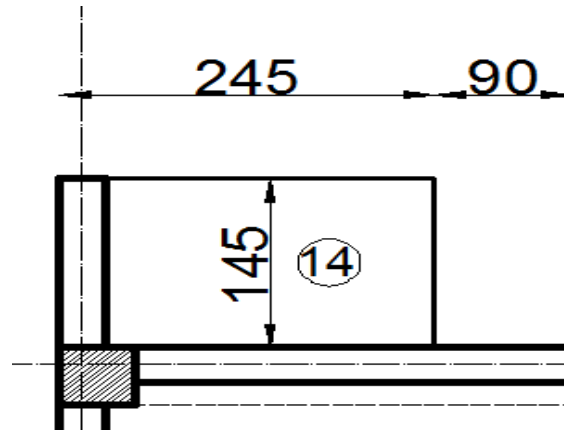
Schéma d'une dalle pleine sur 2 appuis
